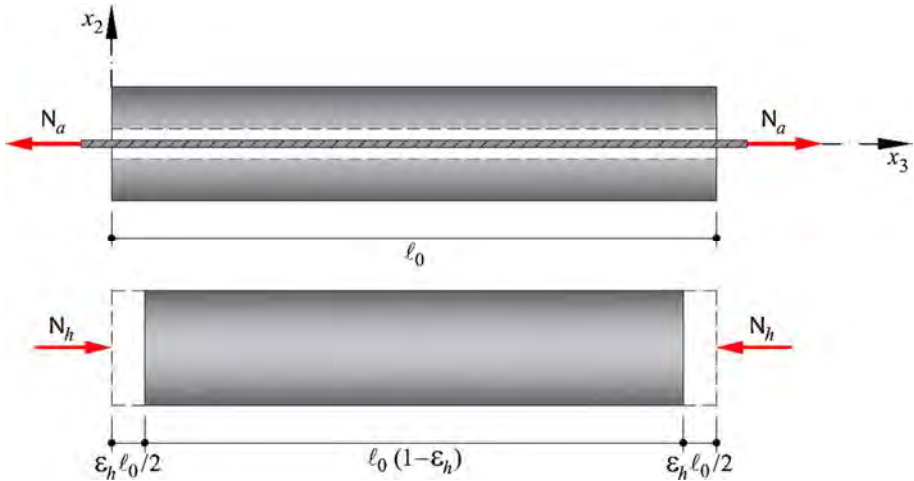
Prisma de hormigón pretensado sin adherencia con armaduras postesas.
